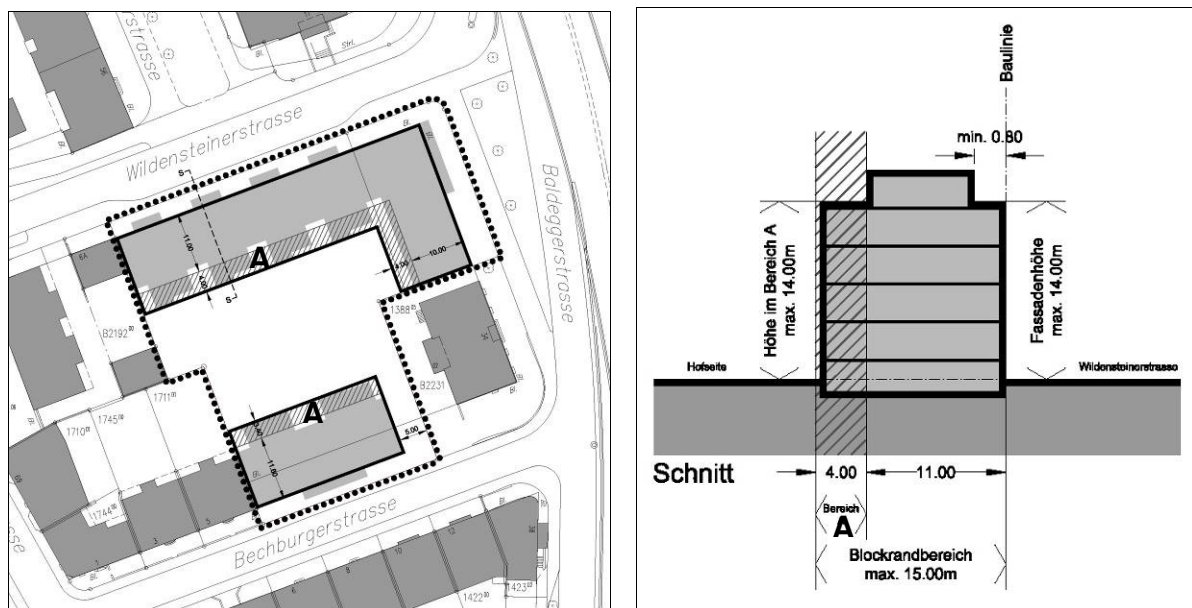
& 7: Bebauungsplan, Plan Nr. 13'259 inkl. Schnitt. (Kein Massstab, Bebauungsplan genordet)
